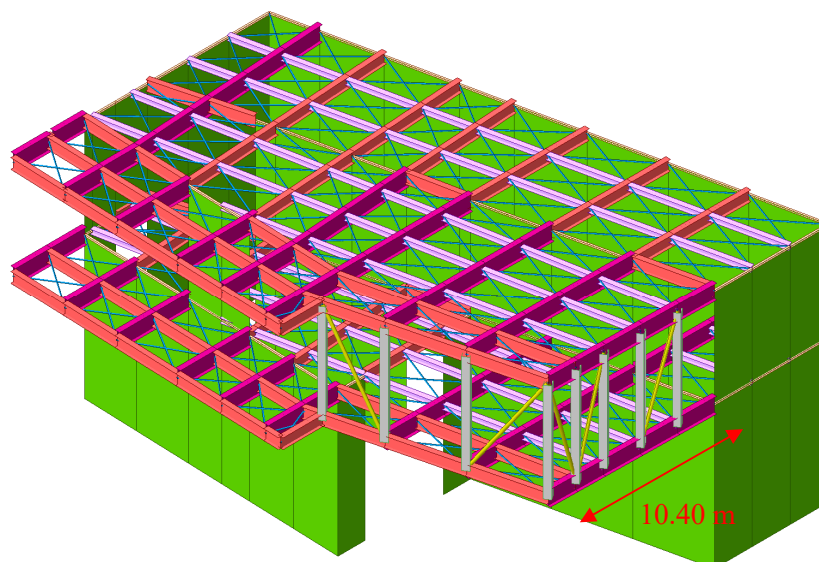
Porzione di solaio a sbalzo – Primo Piano
